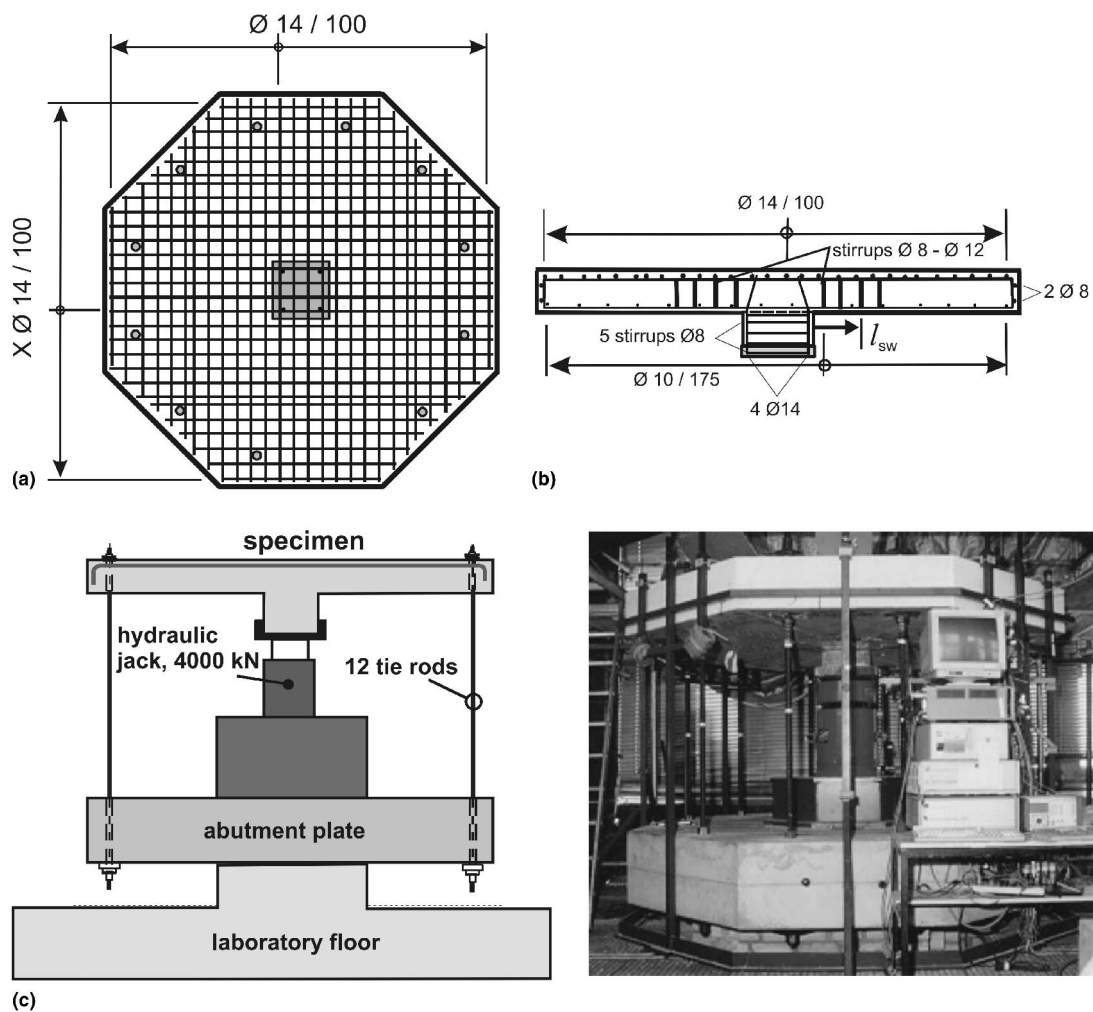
(a) Armadura de longitudinal superior; (b) Pormenor transversal das lajes; (c) Sistema de ensaio [7].
